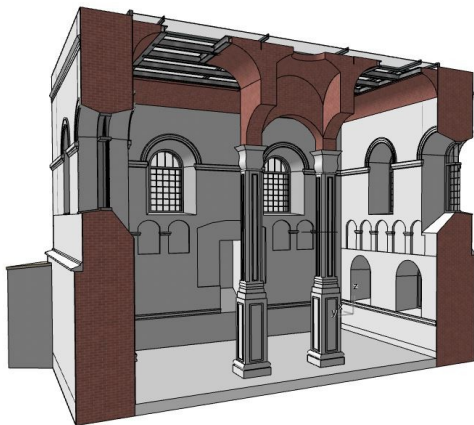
Rekonstruktion Aufbau 3D Schnitt
